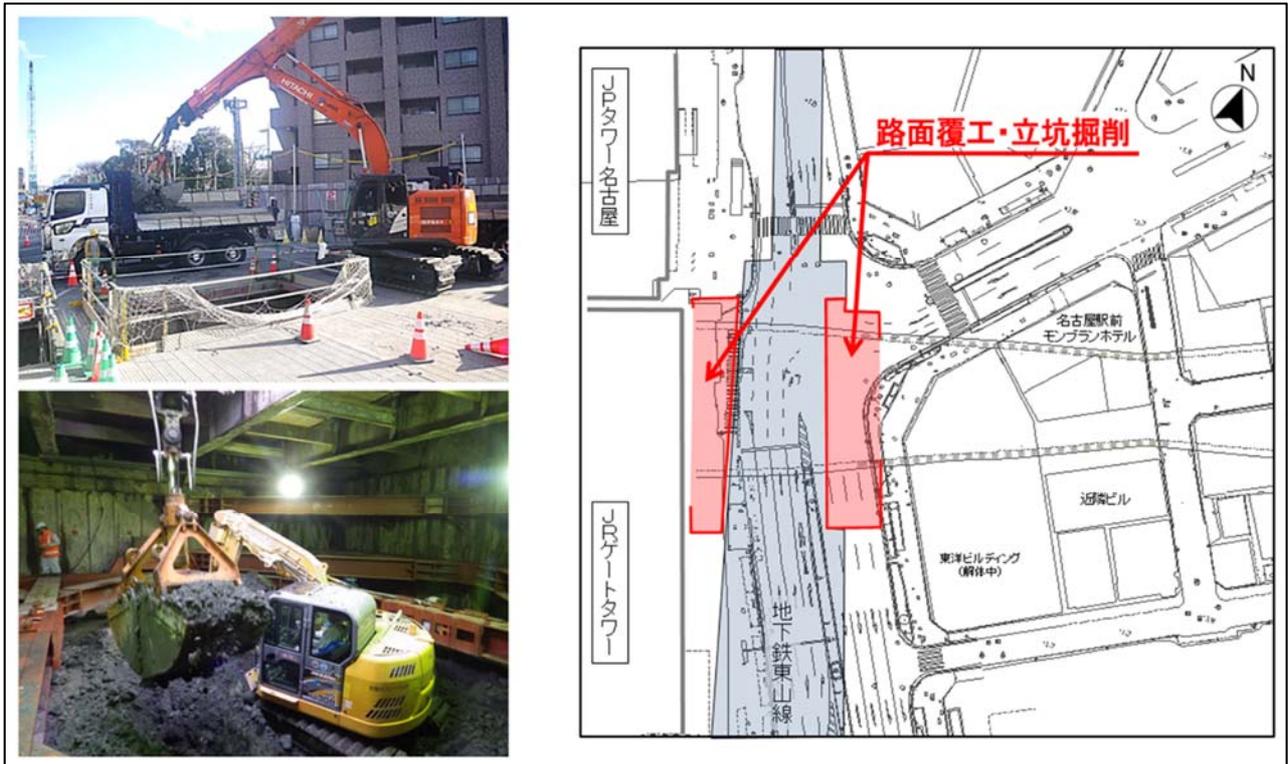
(3) 立坑掘削工の施工手順（写真は類似工事の例）
